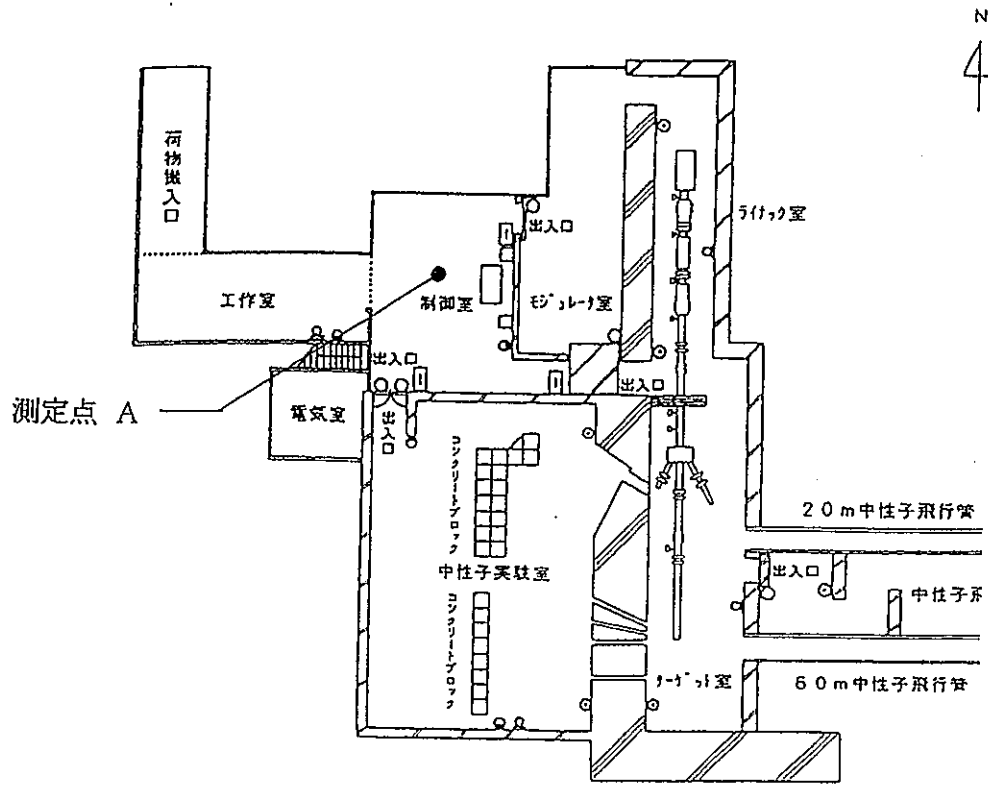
1 建屋地下平面図（ライナック本体の設置個所）と測定点A
